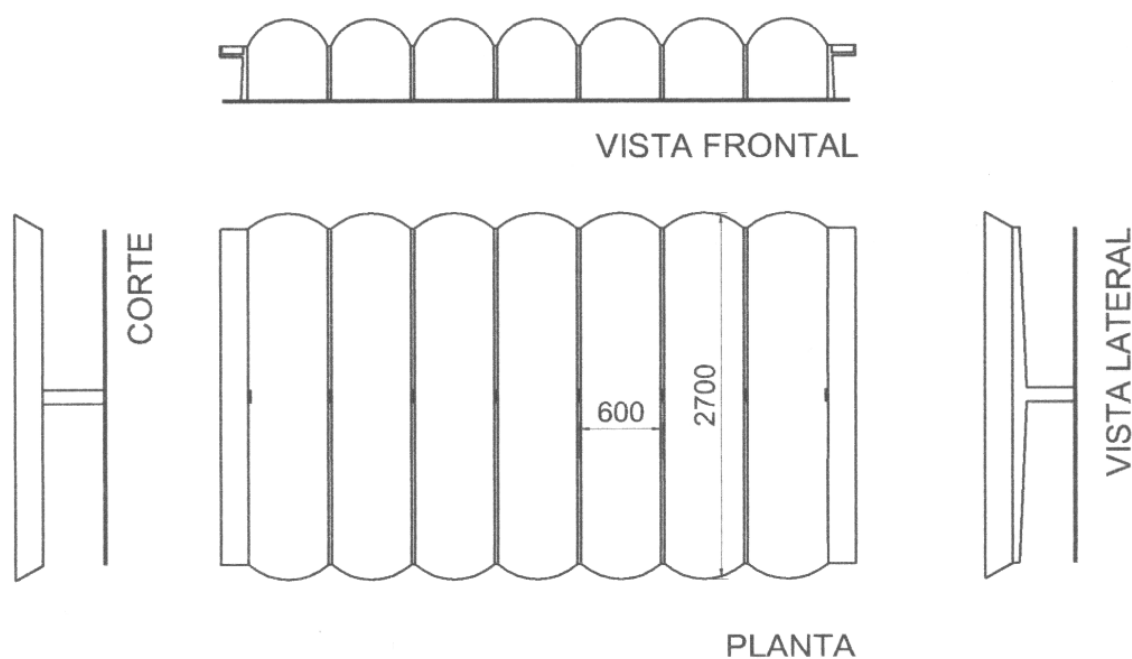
Croqui estrutural da Estação Rodoviária de Salto: planta, vistas e corte.
